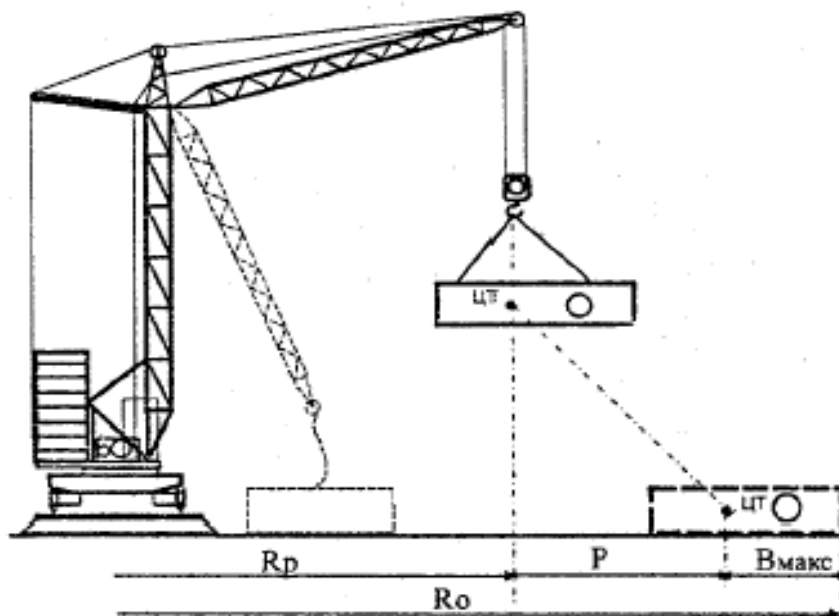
Расчет радиуса опасной зоны работы башенного крана.
